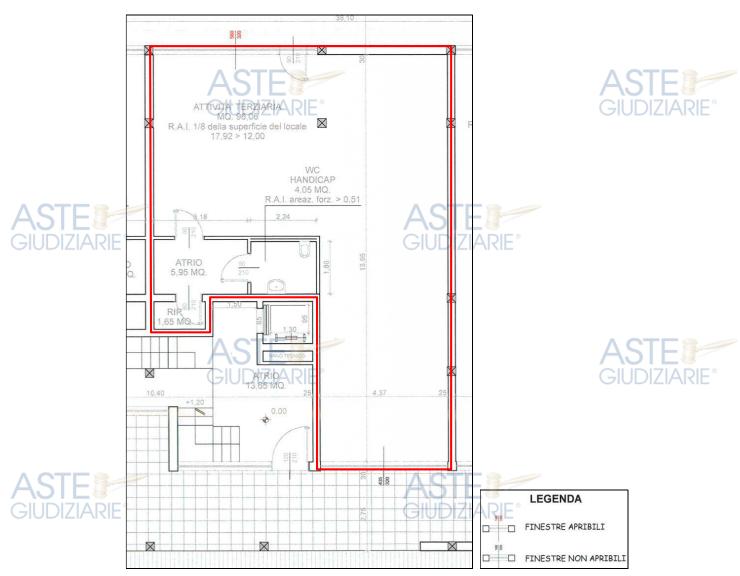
Estratto Tav. 01 pianta piano terra variante D.I.A. Prot. 52454 del 05.12.2006
